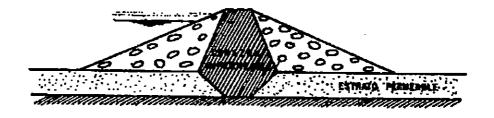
Cimentación con estrato de suelo impermeable de poco espesor
